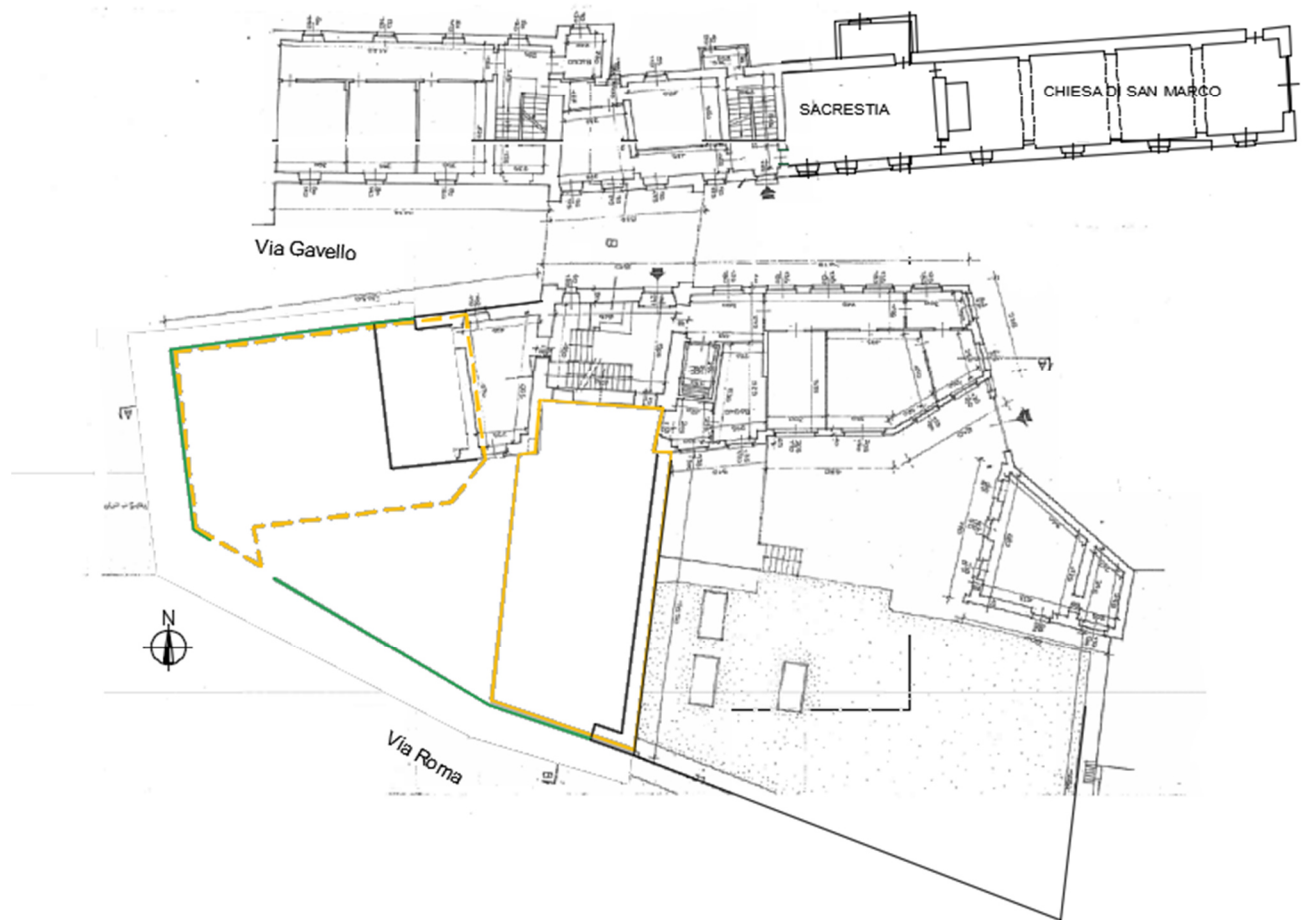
planimetria generale del complesso edilizio al luglio 2017
